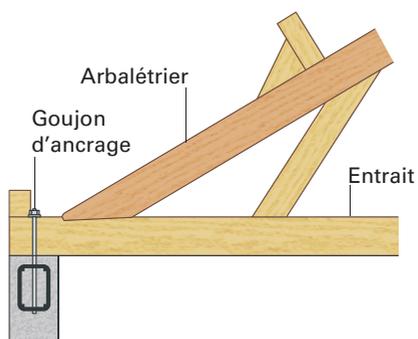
Ancrage de la charpente dans le béton par goujon d'ancrage
